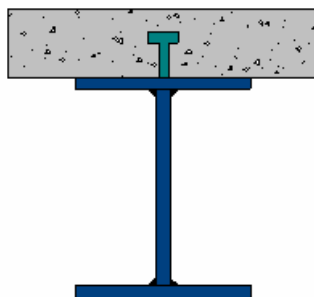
Seção transversal de uma viga-mista aço-concreto
